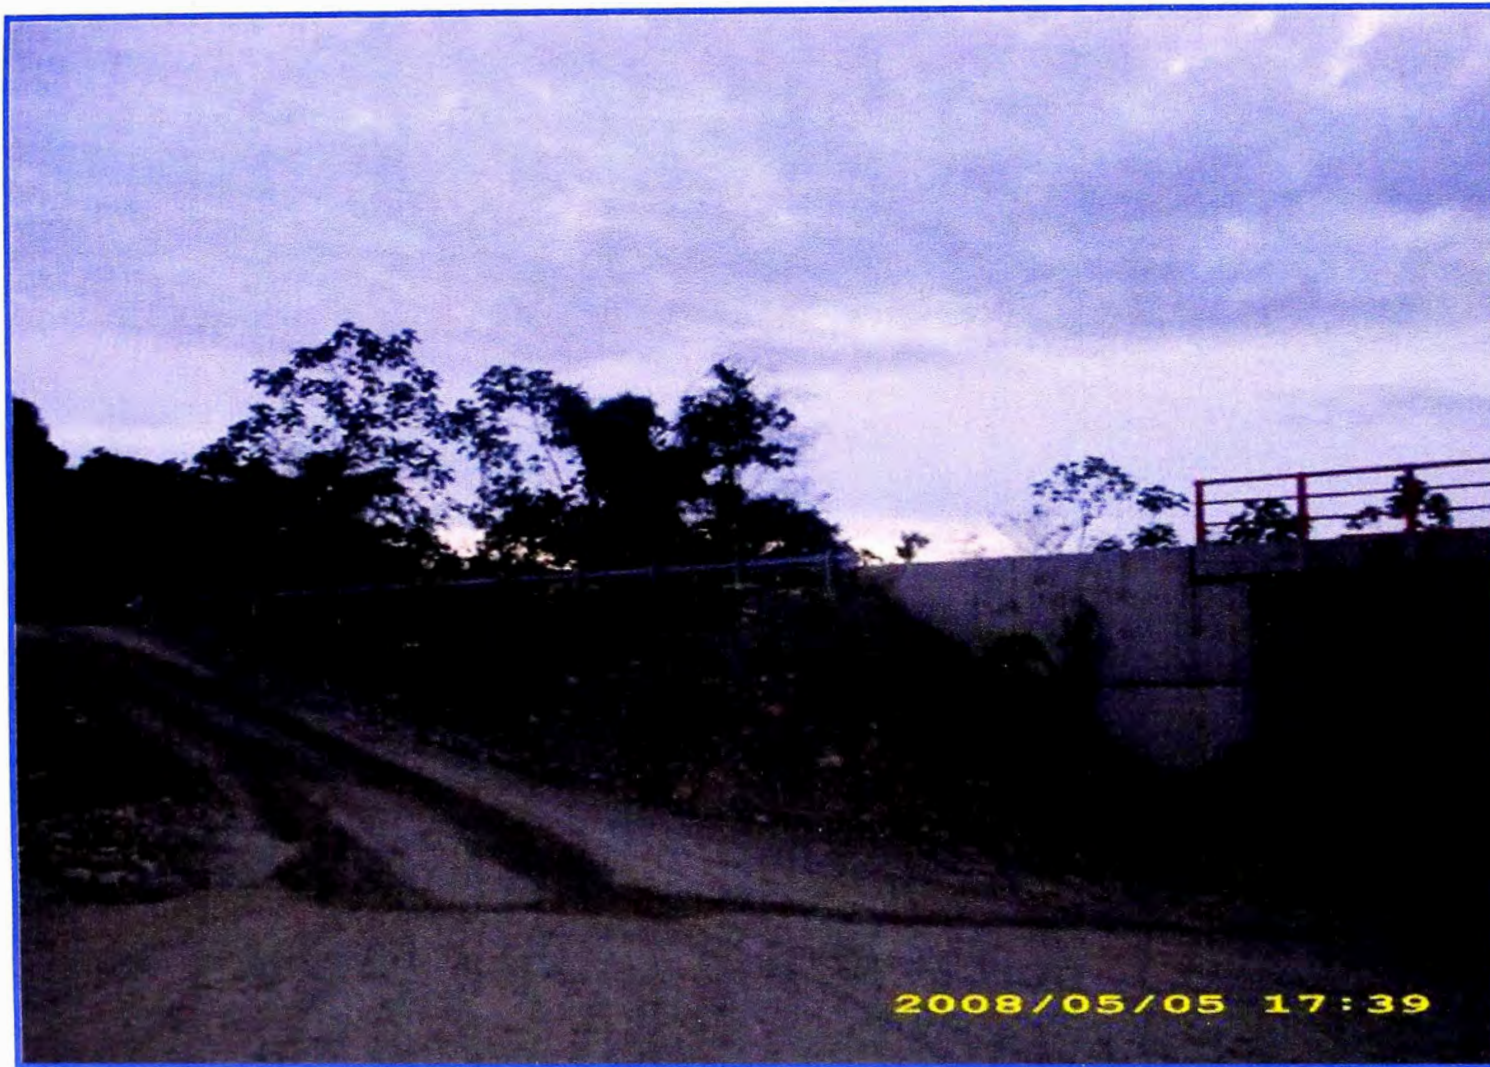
Vista Lateral de Puente desde el Estribo.
